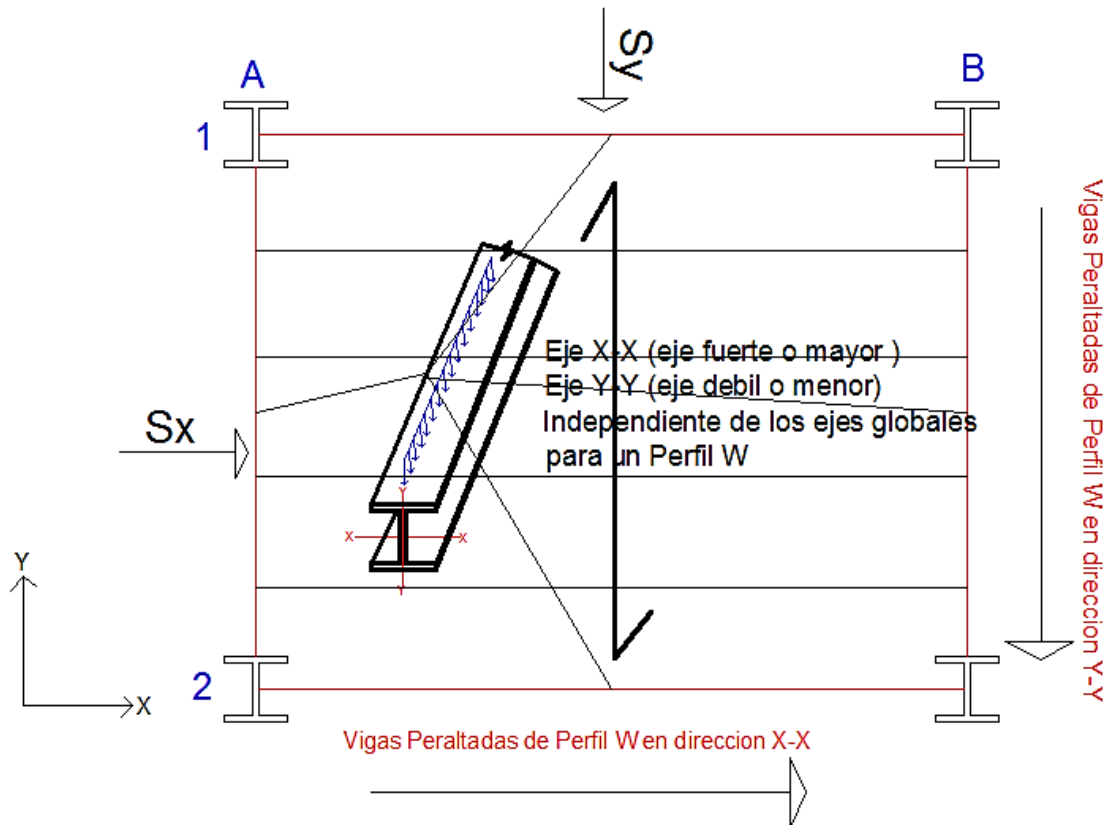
Estructuración de las vigas de pórtico en "X" y "Y"
